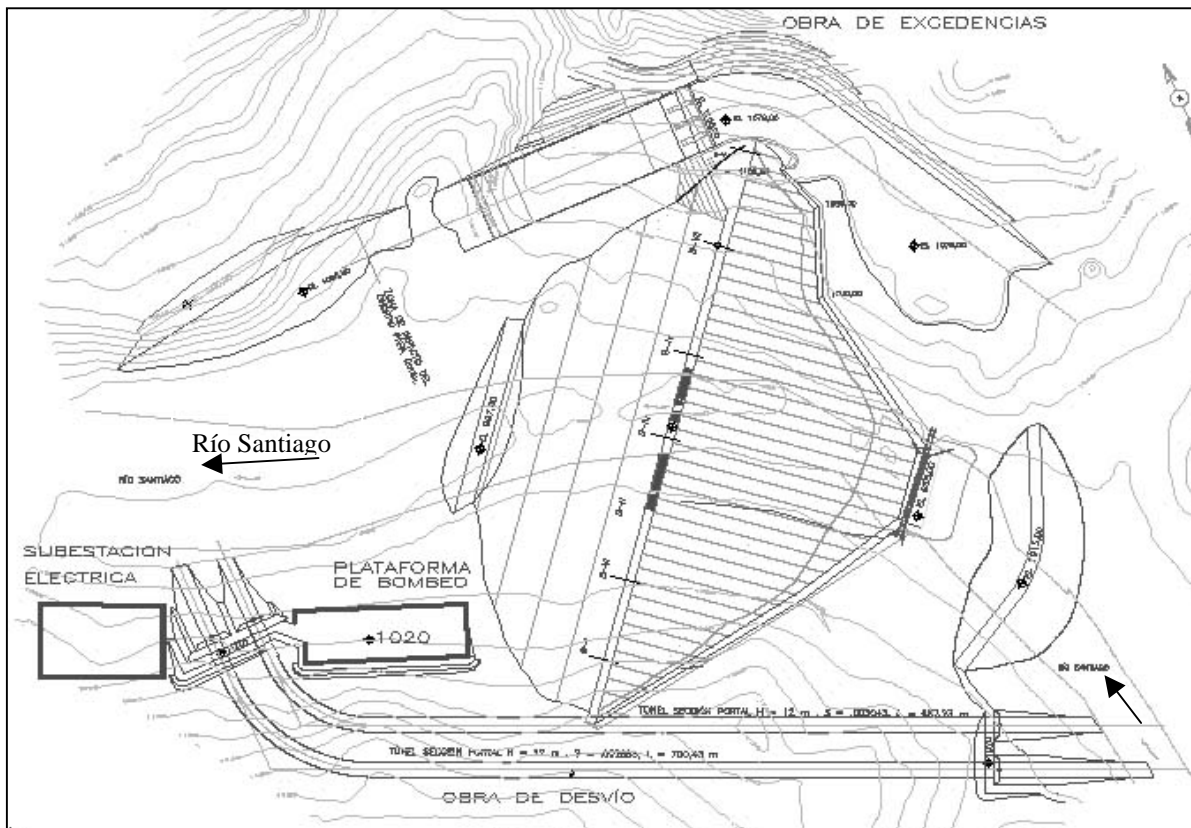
Esquema en planta de la presa Arcediano.
